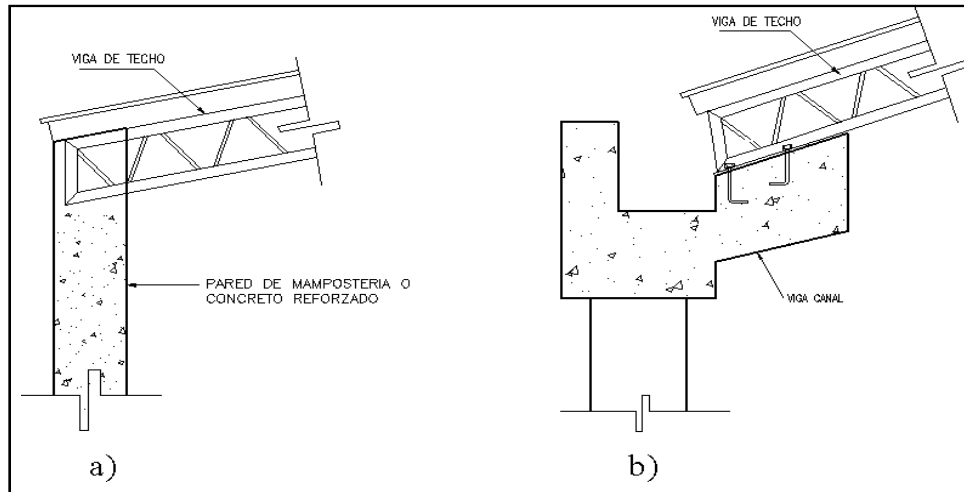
Vigas de Techo Embebidas en los Elementos de Apoyo.
